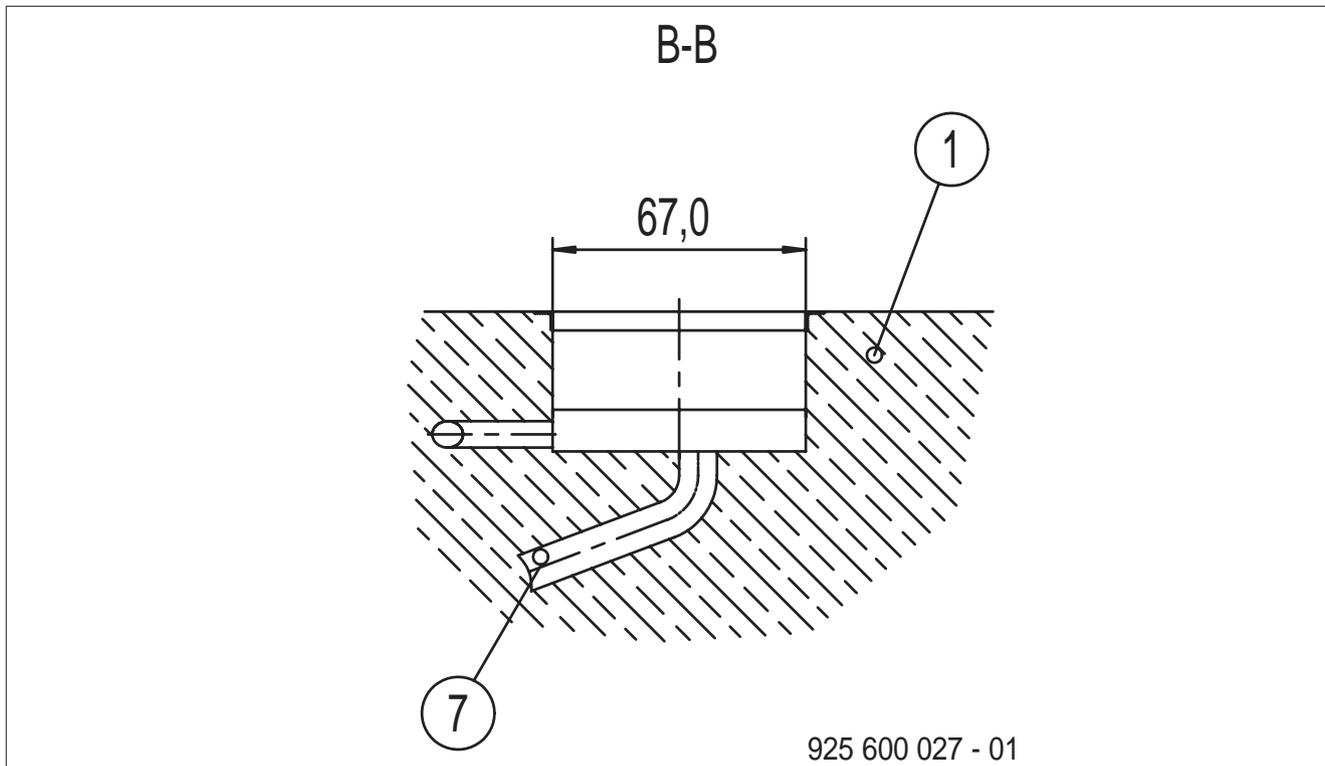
Grubenplan BD 6xx mit Standsäule - Schnitt B-B
